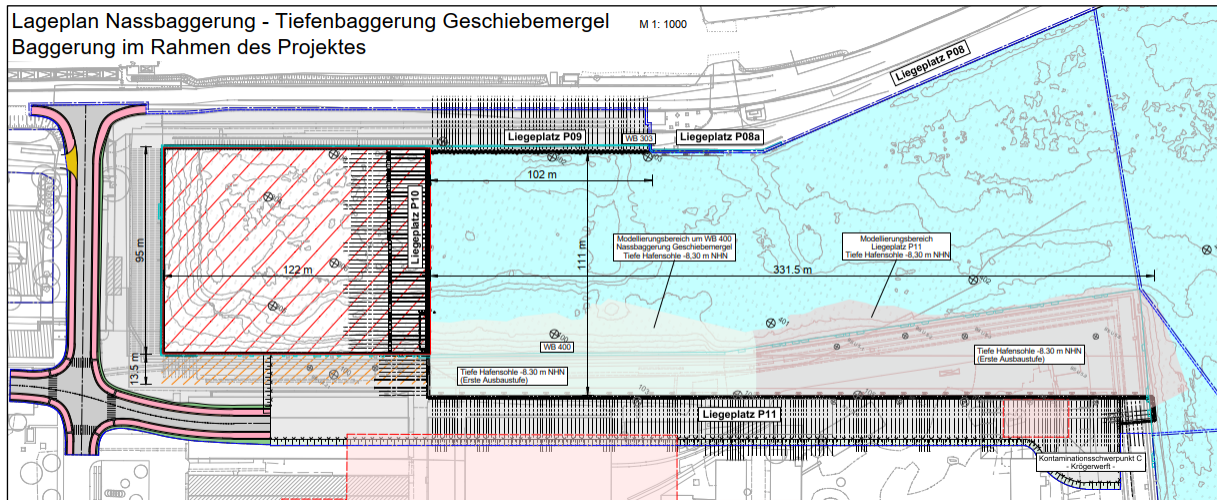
Lageplan Nassbaggerung – Geschiebemergel (erste Ausbaustufe Liegeplatz P11)
